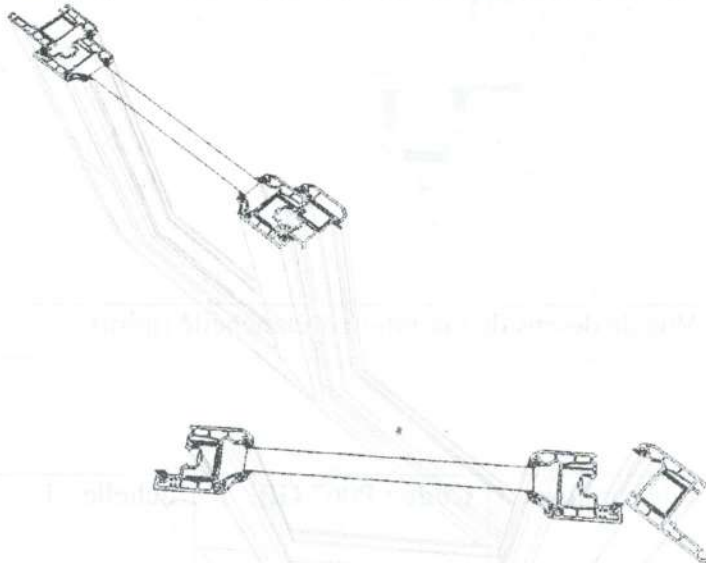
Coupe 3D d'une fenêtre Général Profile montrant l'assemblage de cadre avec couvre joint à l'ouvrant fenêtre ainsi que l'ouvrant avec le battement centrale.
